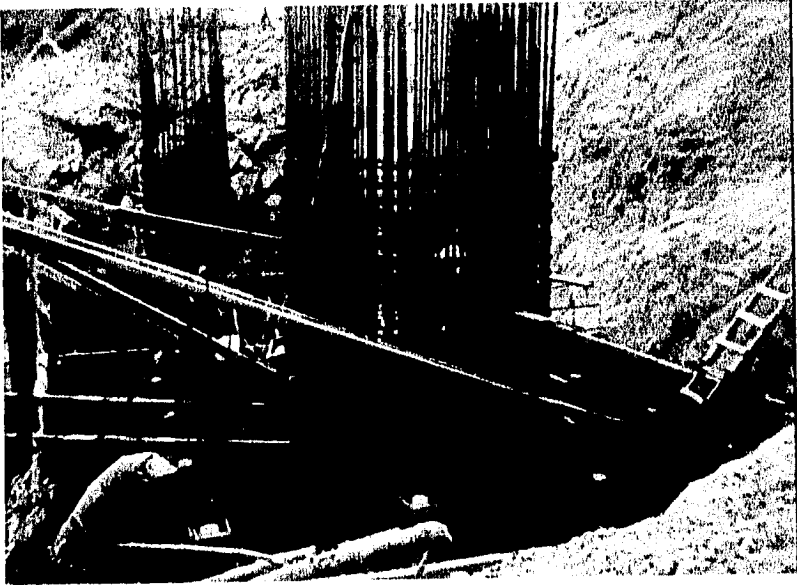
Armado del acero de refuerzo en zapatas y columnas y colocación de cimbra en Pila No. 3.
